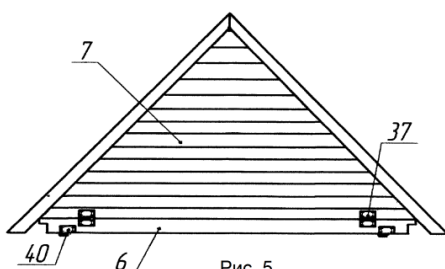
Фронтон двускатной крыши с поперечной балкой:
